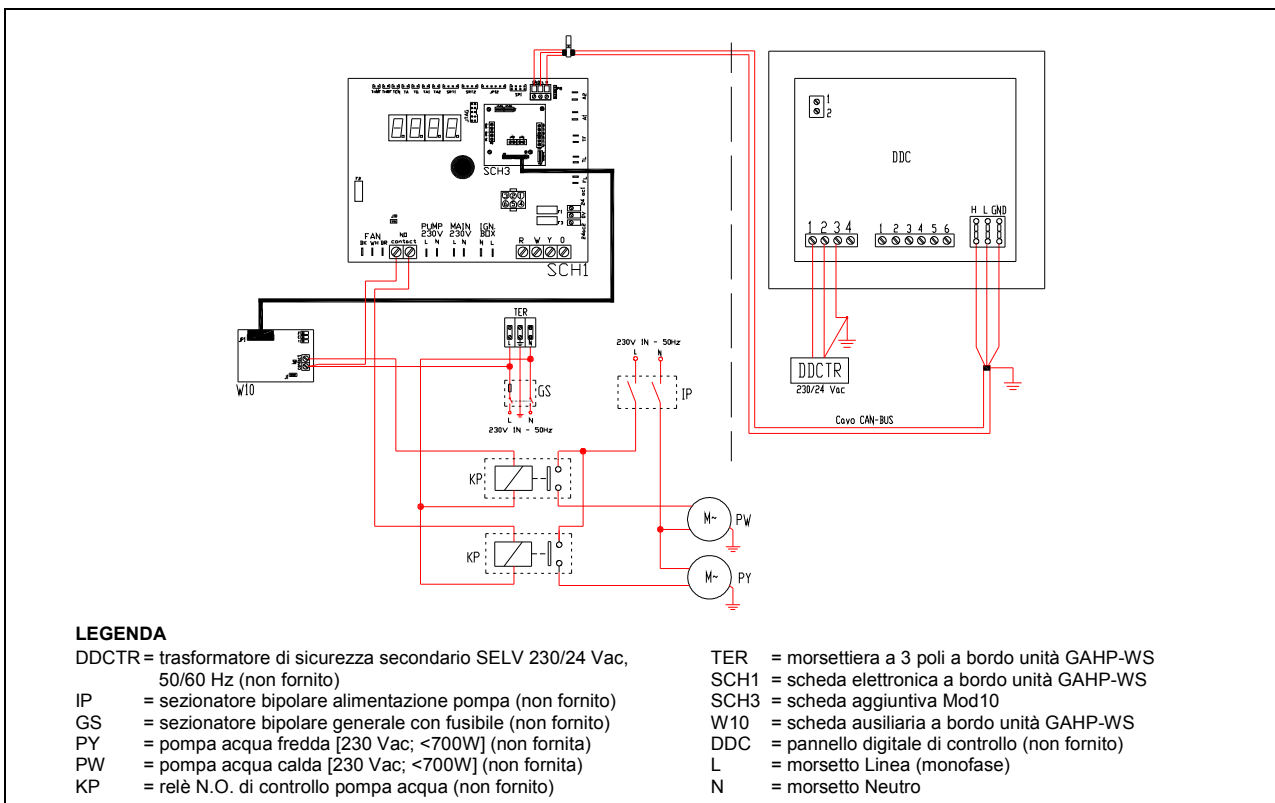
Esempio collegamento elettrico singola GAHP-WS
